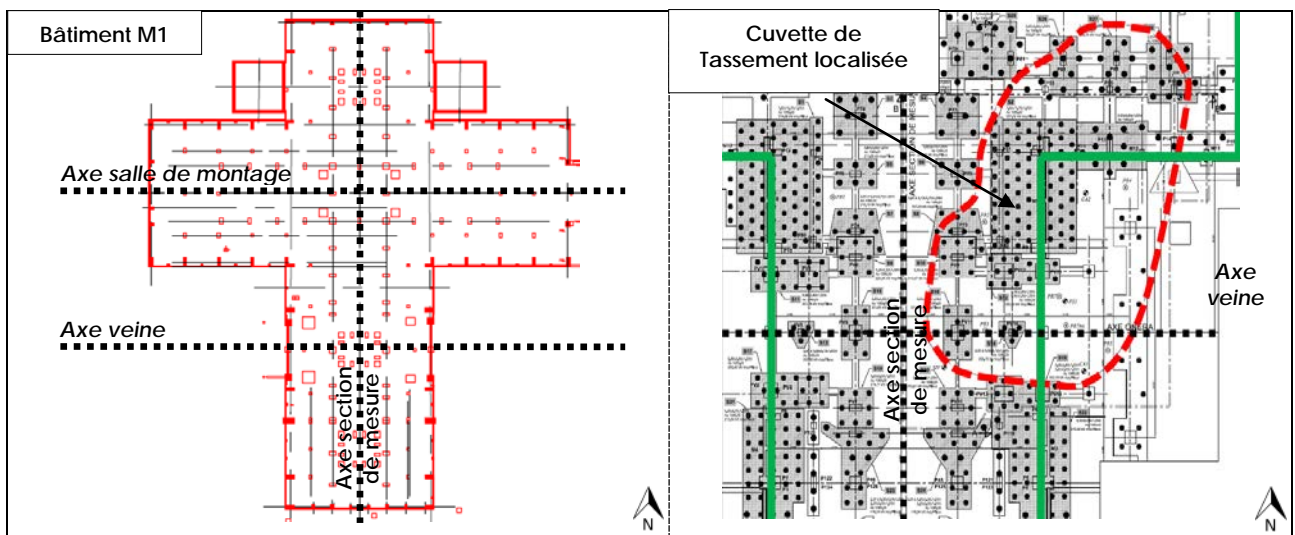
Vue en plan des fondations existante du bâtiment M1 ; cuvette de tassement maximum
